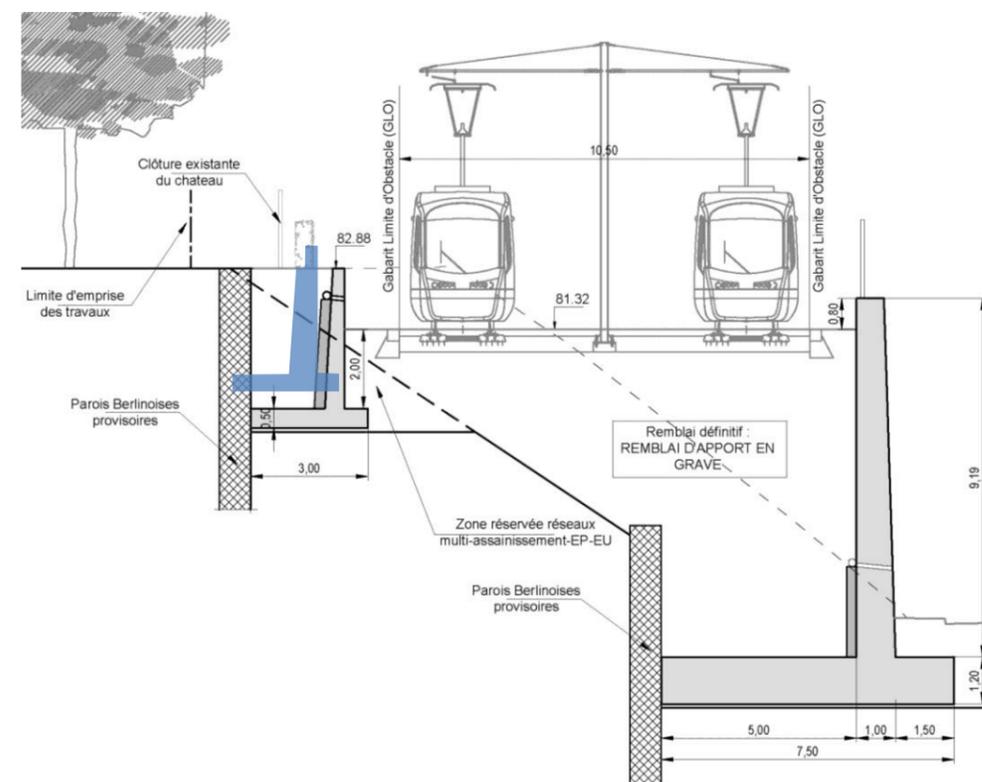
Coupe transversale du mur haut sur fondations superficielles (Source : AVP- juillet 2015)
